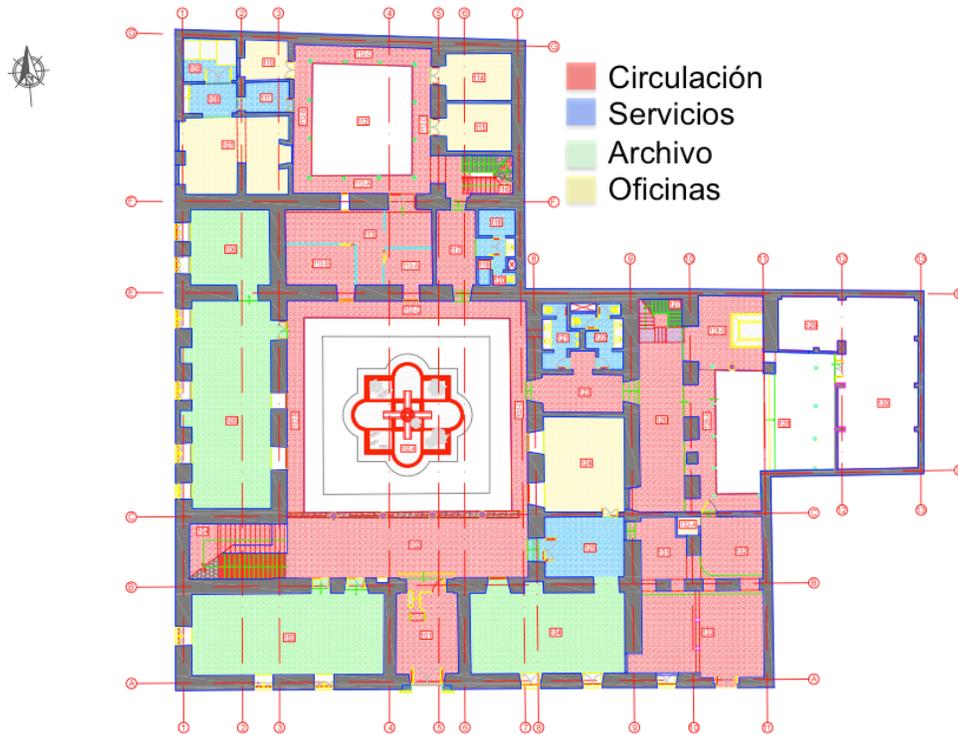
Plano de Uso Actual Planta Baja. MGC. 2014
